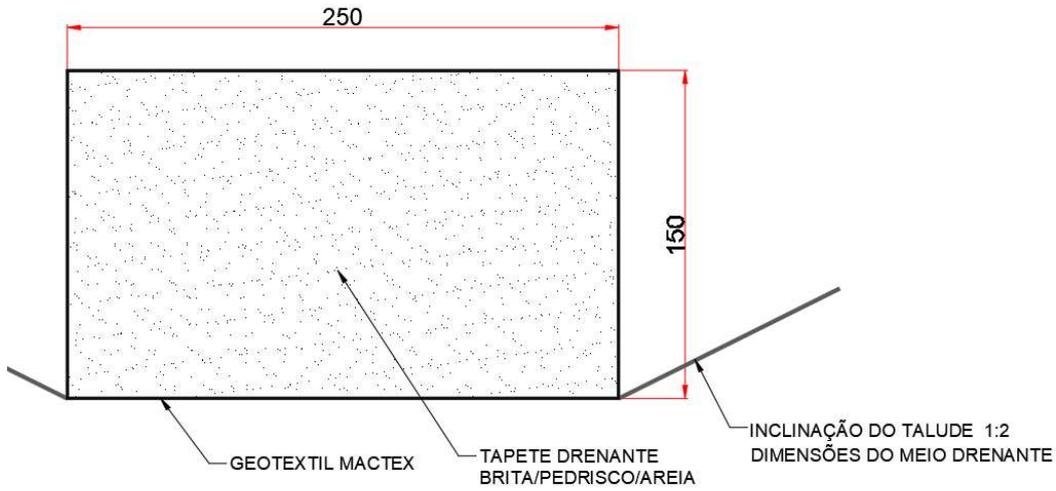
Detalhe: Tapete drenante. Fonte: WEGG PONTA GROSSA, 2017.
